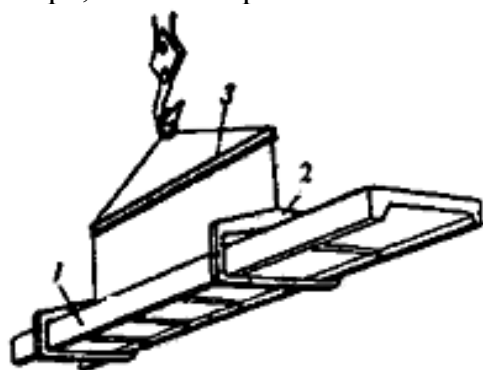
Вилочный захват для без петлевого монтажа ребристых плит: 1 – ребристая плита покрытия; 2 – рама захвата; 3 – траверса
